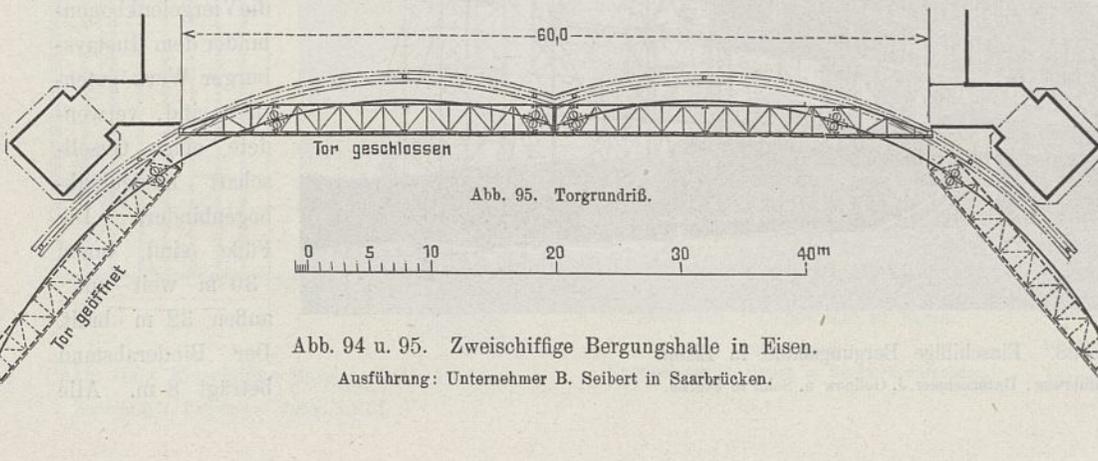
u. 95. Zweischiffige Bergungshalle in Eisen.
